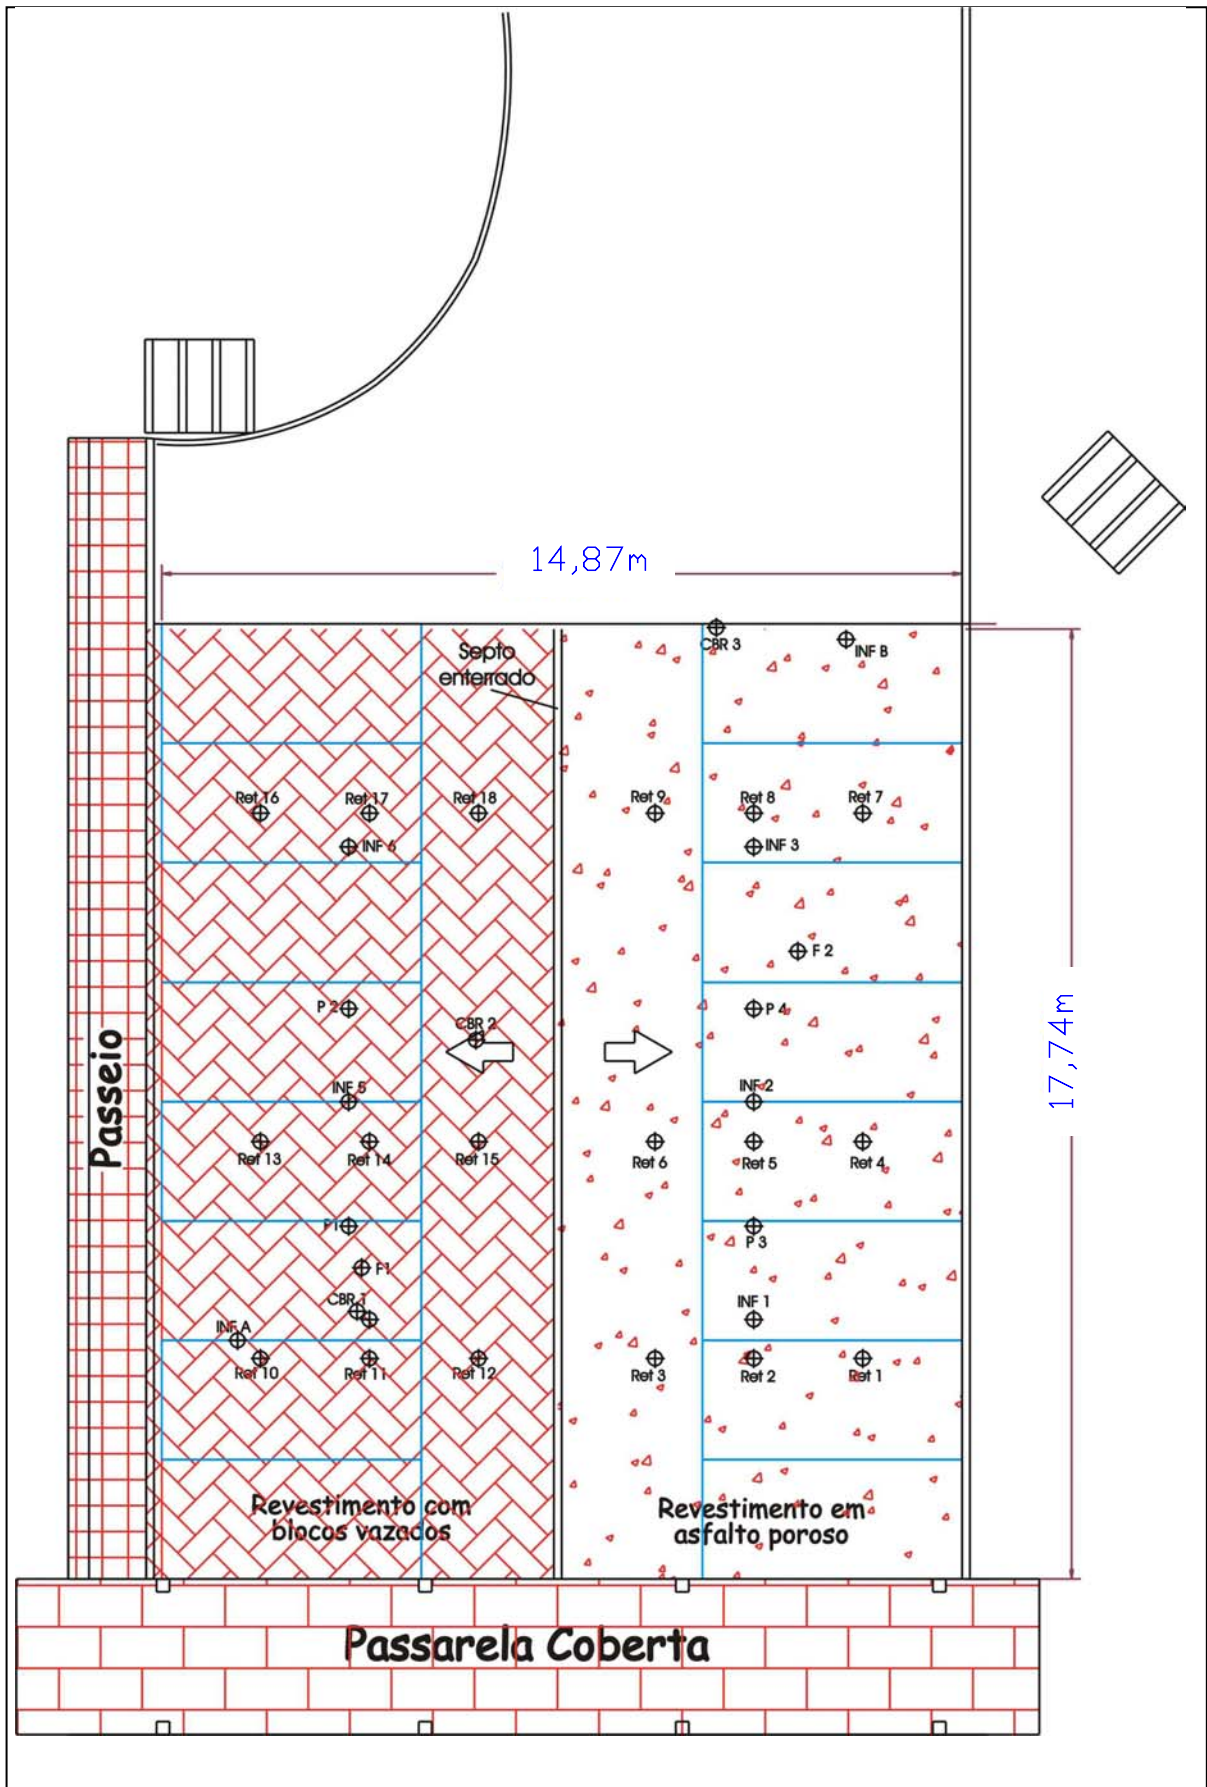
Planta baixa do pavimento com suas principais dimensões e com a localização dos pontos de coleta de amostras para realização dos ensaios de caracterização do solo.
